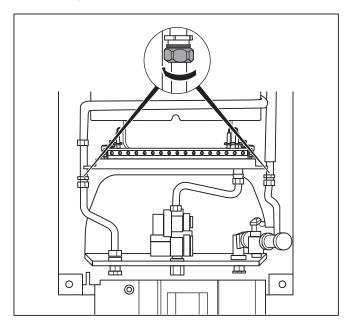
Raccordi a vite per gli attacchi dell'acqua del corpo scaldante
